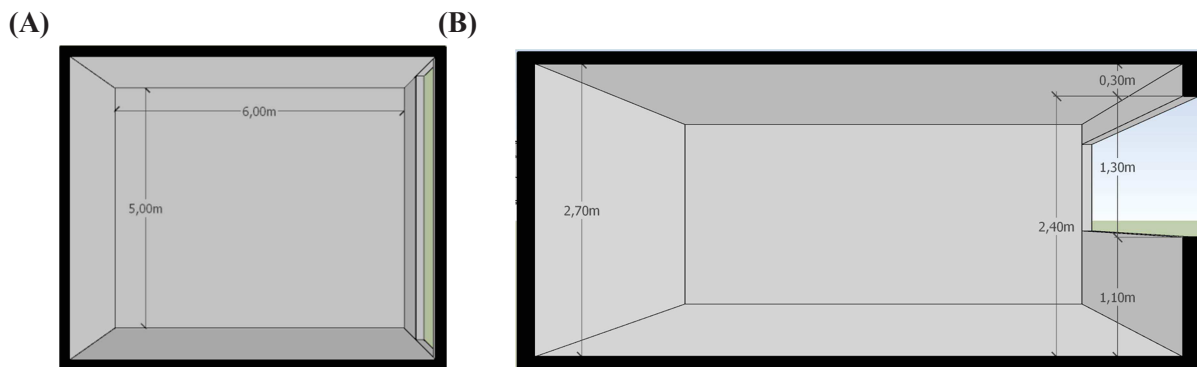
Planta Baixa e Corte esquemáticos fugados com as dimensões do modelo de ambiente interno: (A) planta baixa; (B) corte.
